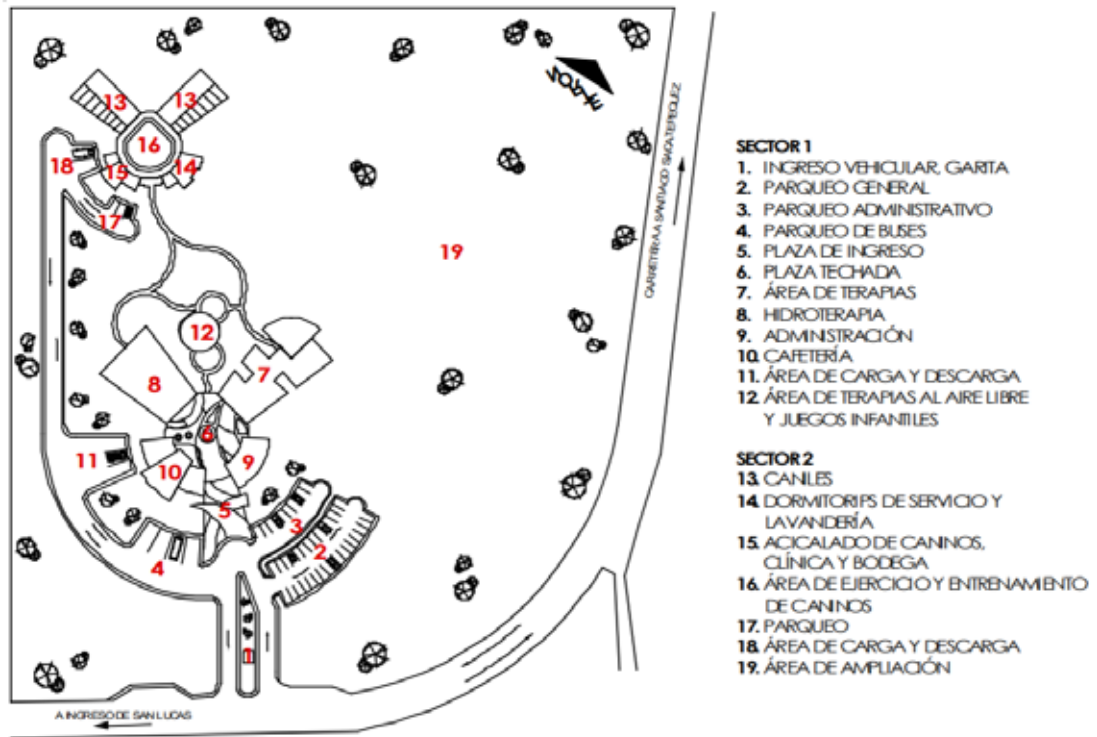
Plano de planta conjunto del Centro de Zooterapia.
